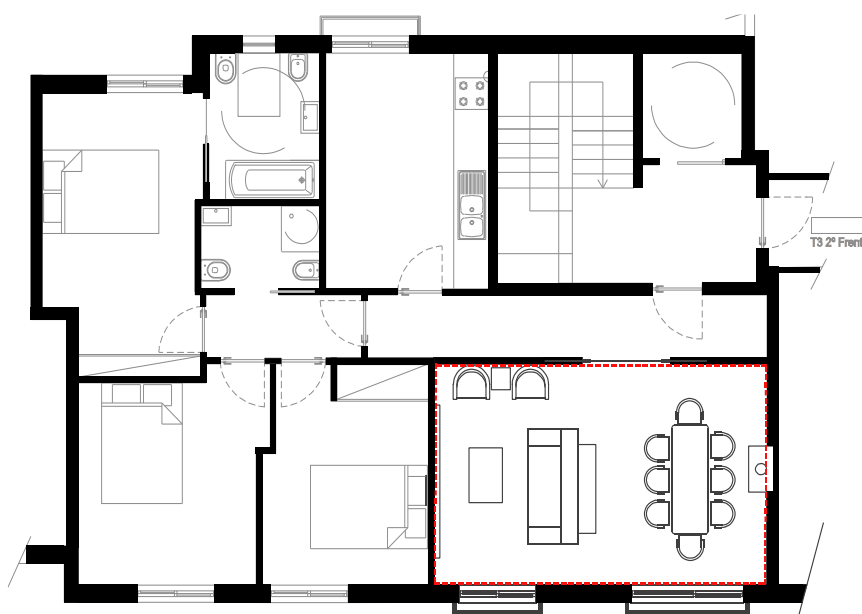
Planta Proposta - Fração D. Fonte: Biblioteca do gabinete
